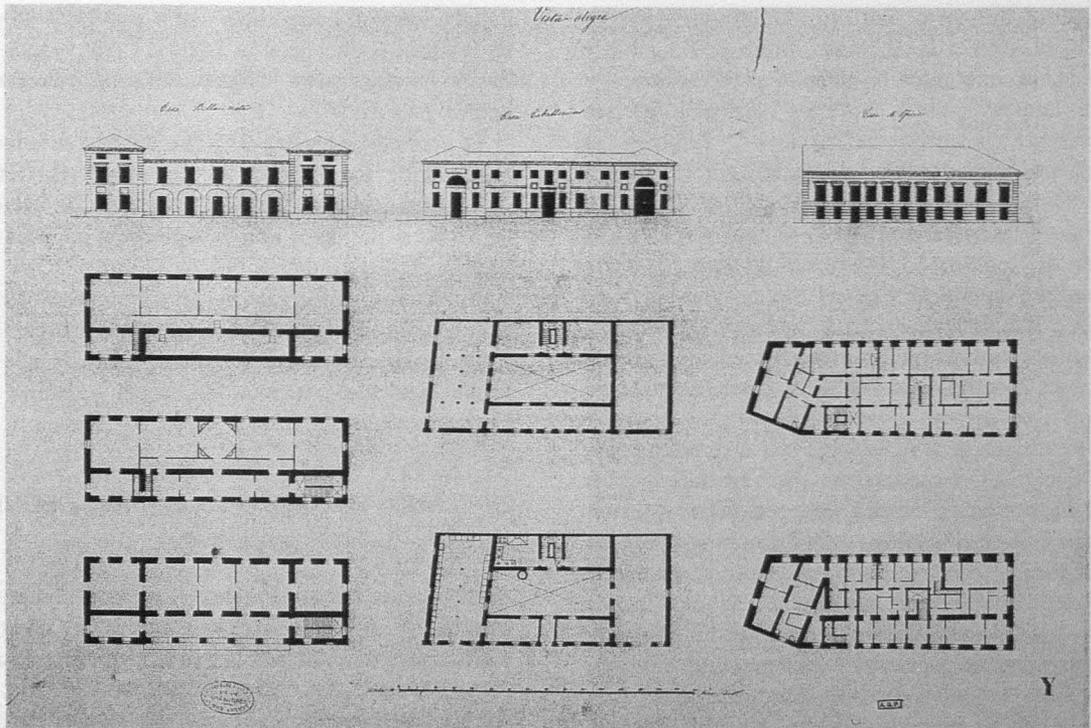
Plantas y alzados de las casas de Bella Vista, Caballerizas y Oficios (tinta china sobre cartulina, 510 por 724 mm. Escala: gráfica en pies castellanos). Sección planos, n° 3.516, A.G.P., Madrid.
